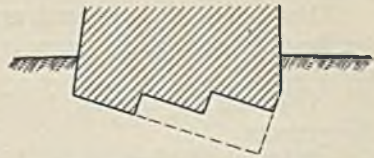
Einschränkung des Gründungsmauerwerkes bei Gründung auf sehr festen Bodenarten.
